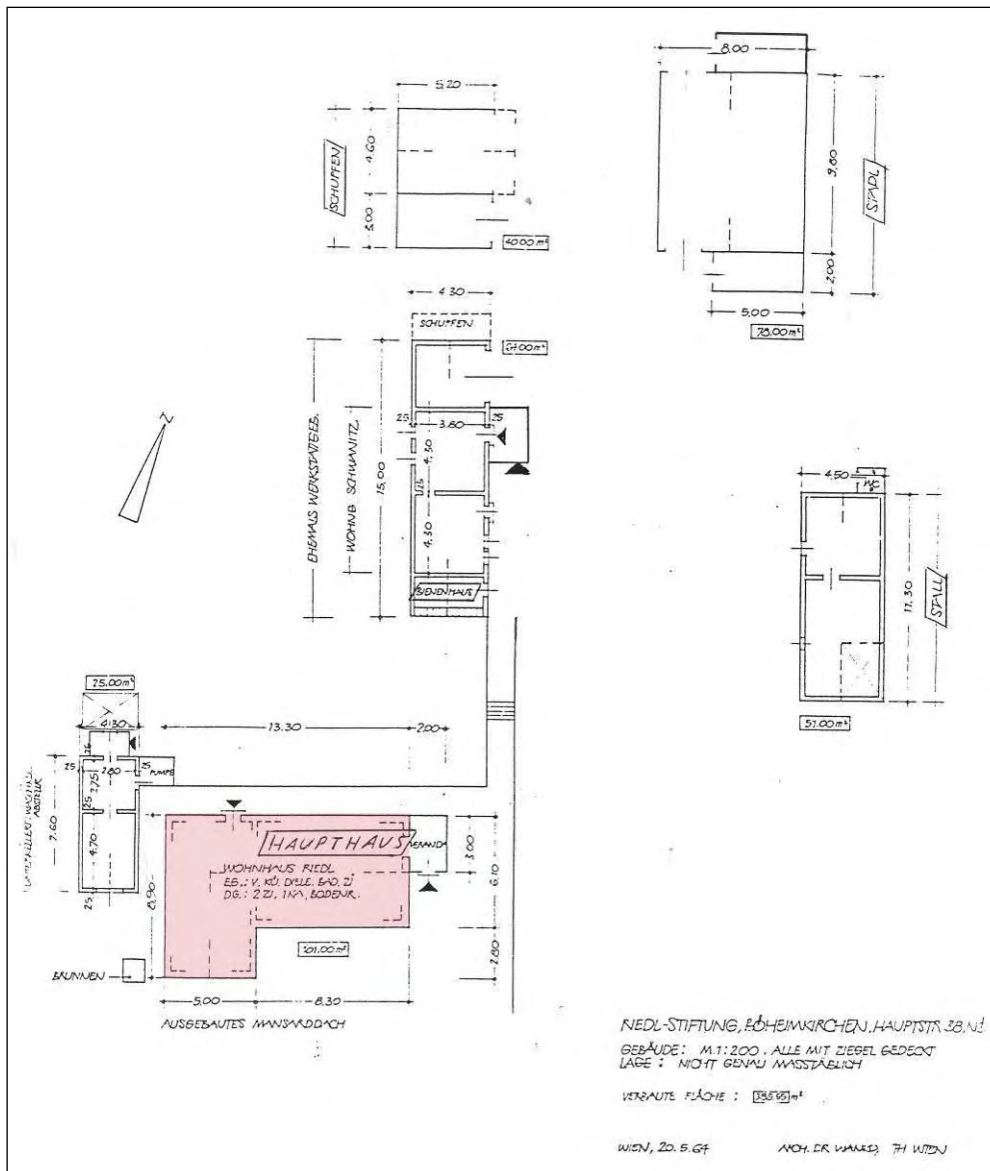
Lageplan des Sanierungsobjekts im Bestand
